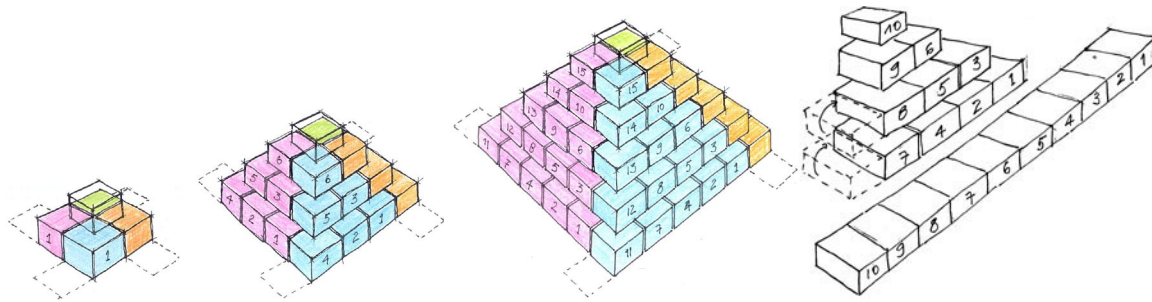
Principe de la construction par enveloppes successives et détail du montage d'une face (à droite).
